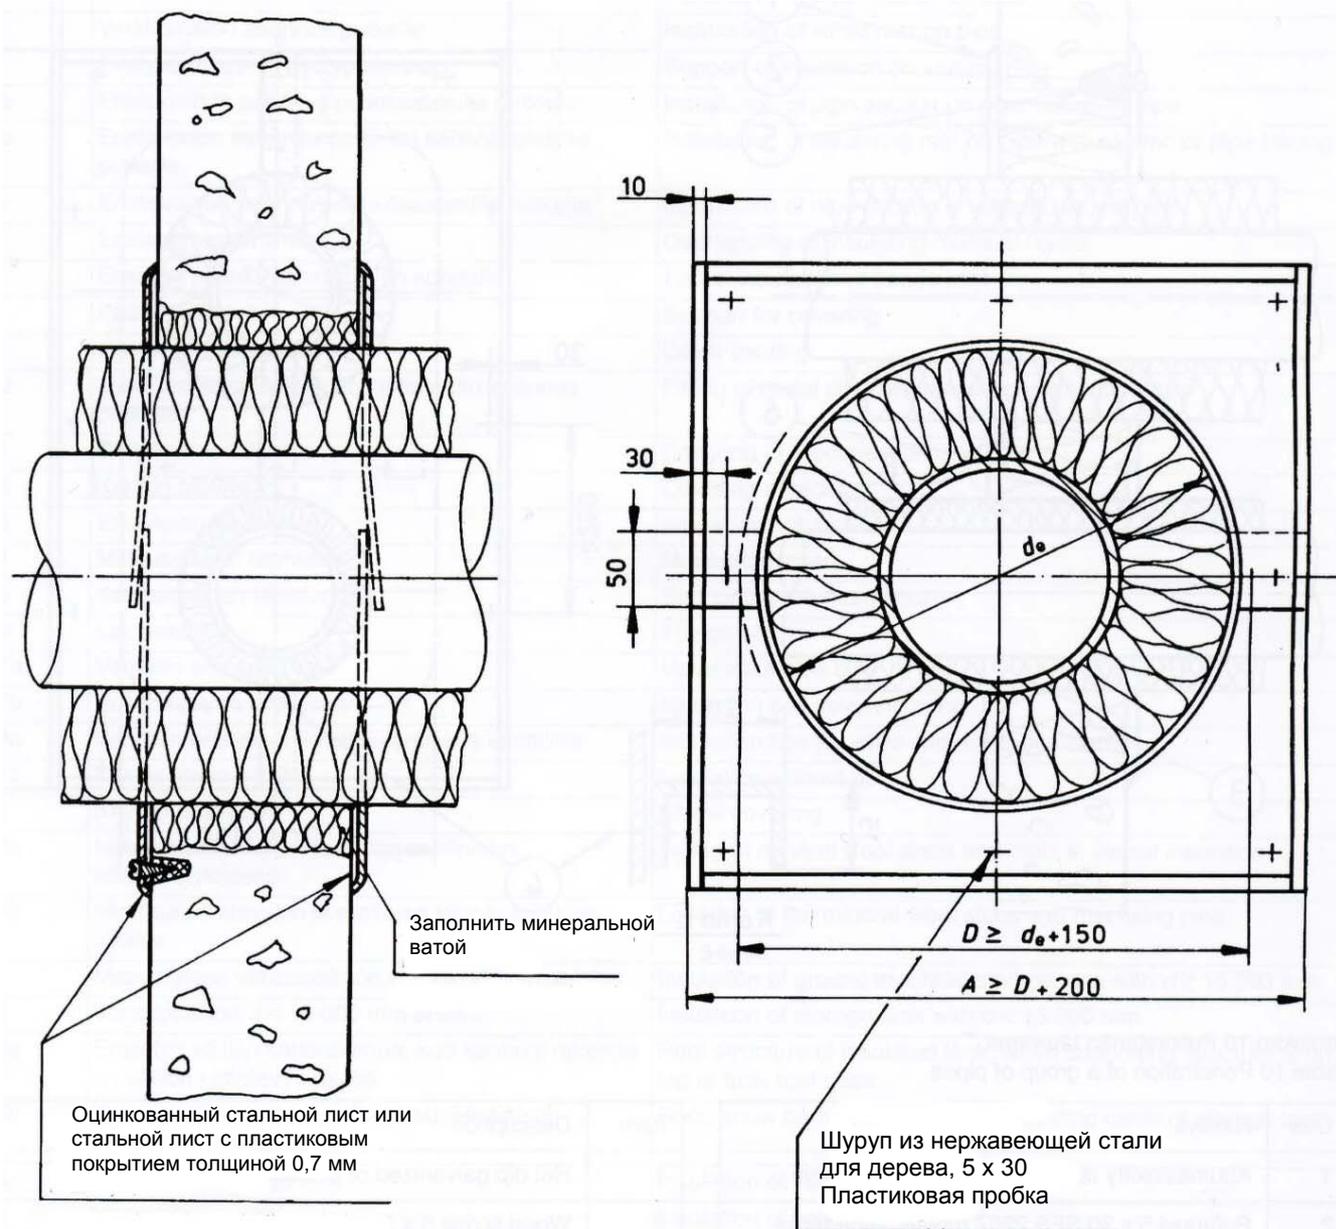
Монтаж трубы с изоляцией при прохождении трубопровода через стену
